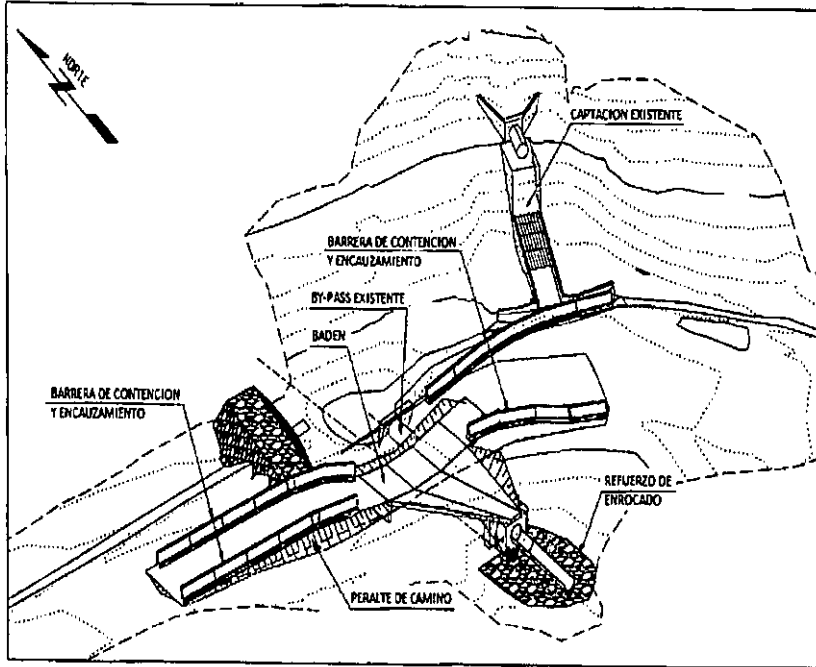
Obras de mejora en Obras de Arte de Canal Norte Inferior
